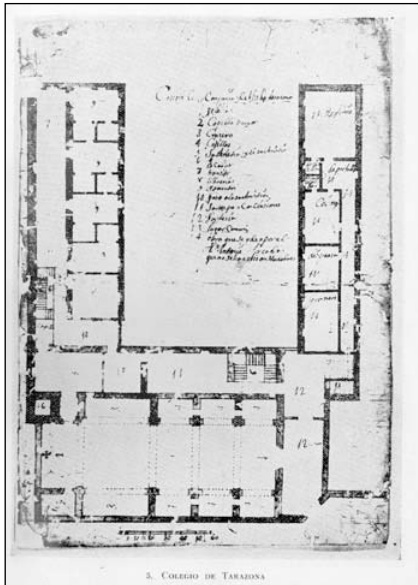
Planta del conjunto de Tarazona según el Padre Forcada. Tomado de FURLONG, G., “Algunos planos...”, op. cit., lám. 5.
